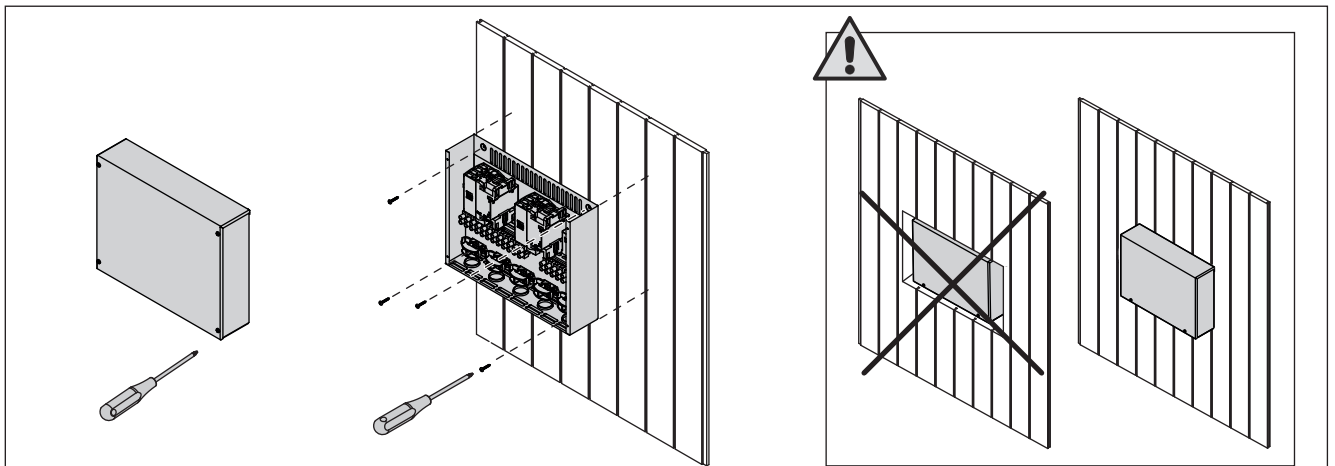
Открывание крышки дополнительного блока питания и его крепление на стене
